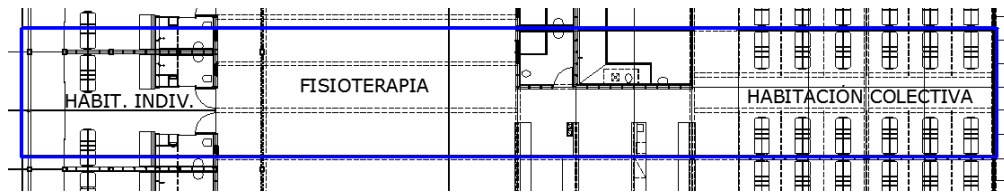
Modelo Sarah Rio - Planta baja de hospitalización - (archivo del CTRS adaptado por la autora)
